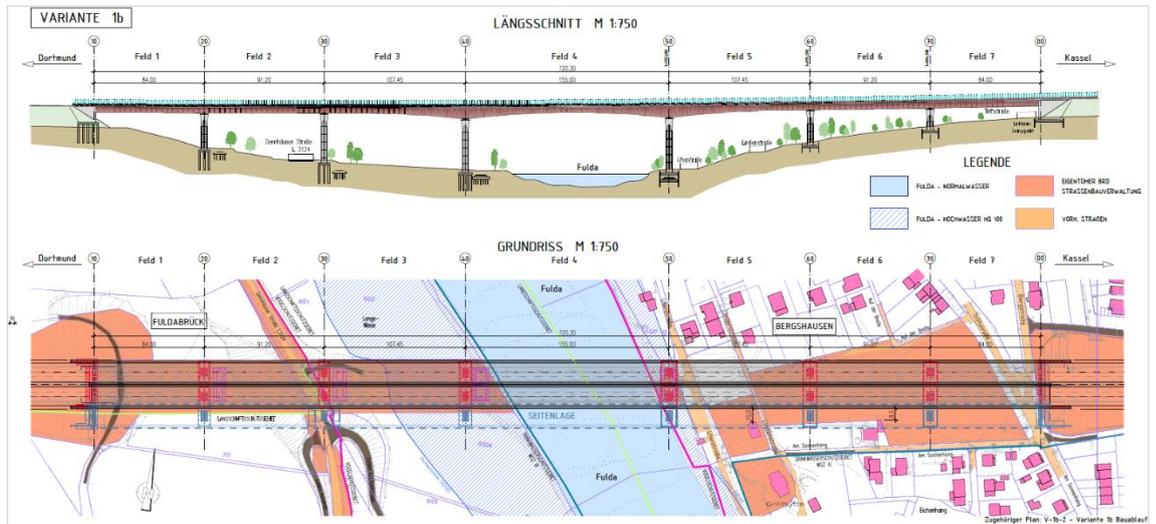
Längsschnitt und Grundriss der Bergshäuser Brücke (BW07) in Variante 1
